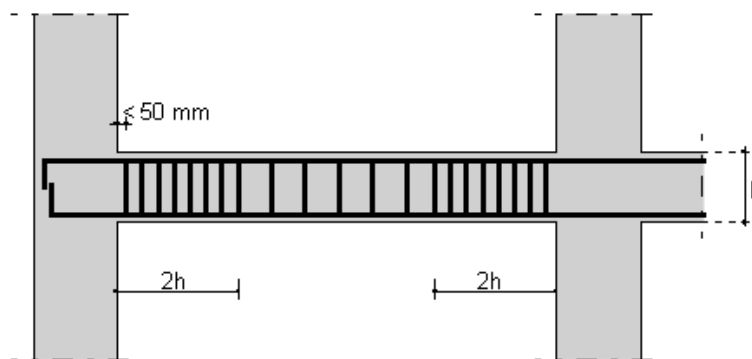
Disposizione dell'armatura trasversale nelle travi.
